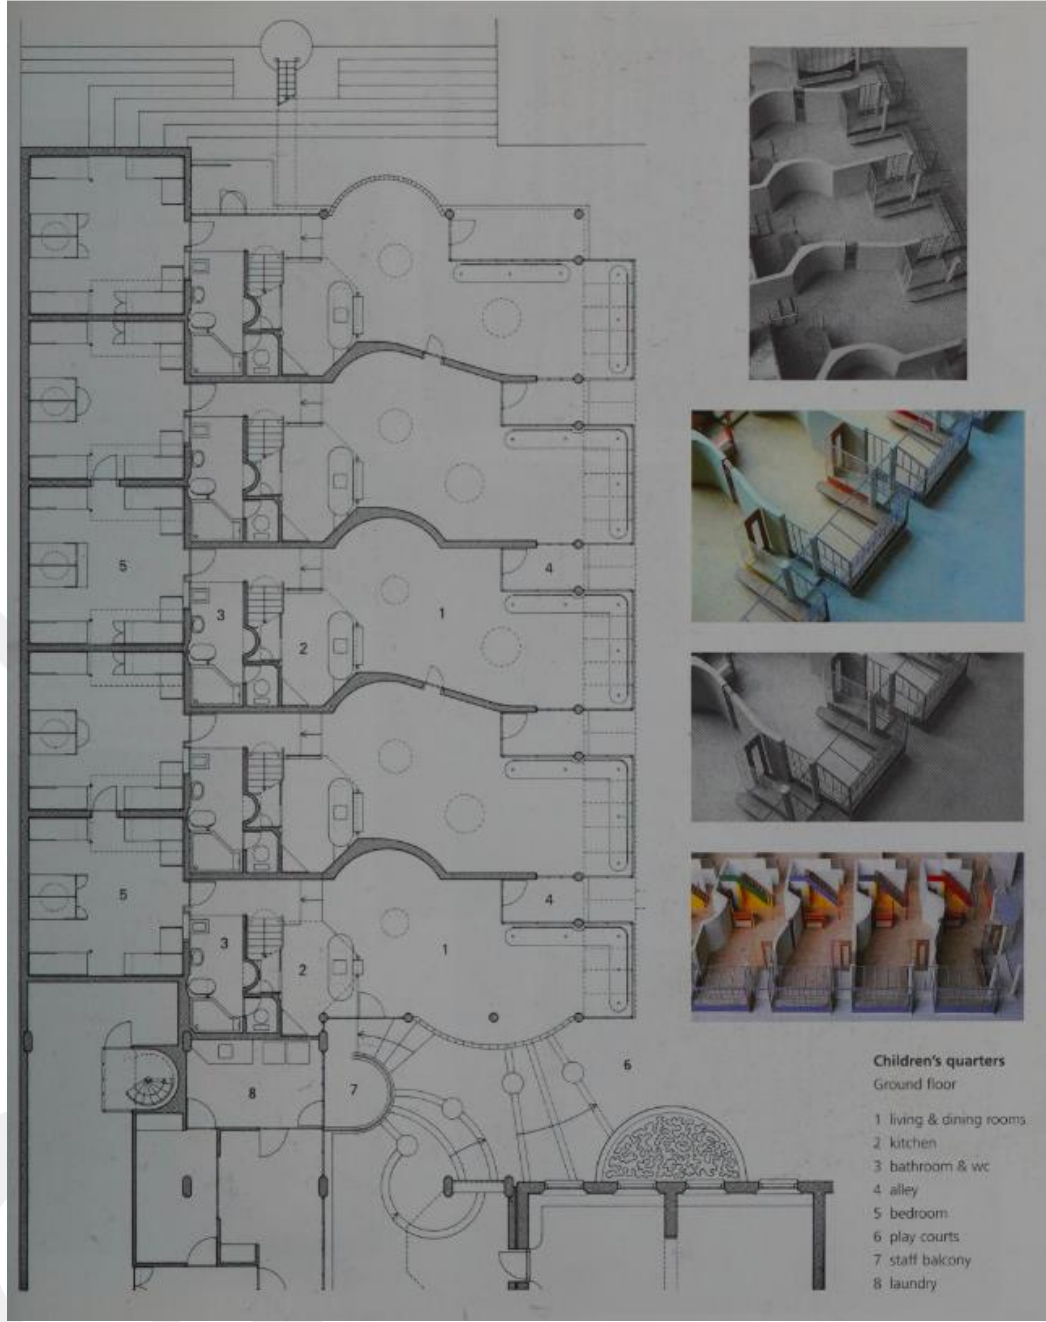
Mothers' House kütlelerindeki yükseklik farklılıkları Kaynak: <https://www.architectural-review.com/buildings/street-urchin-mothers-house-amsterdam-by-aldo-van-eyck>
